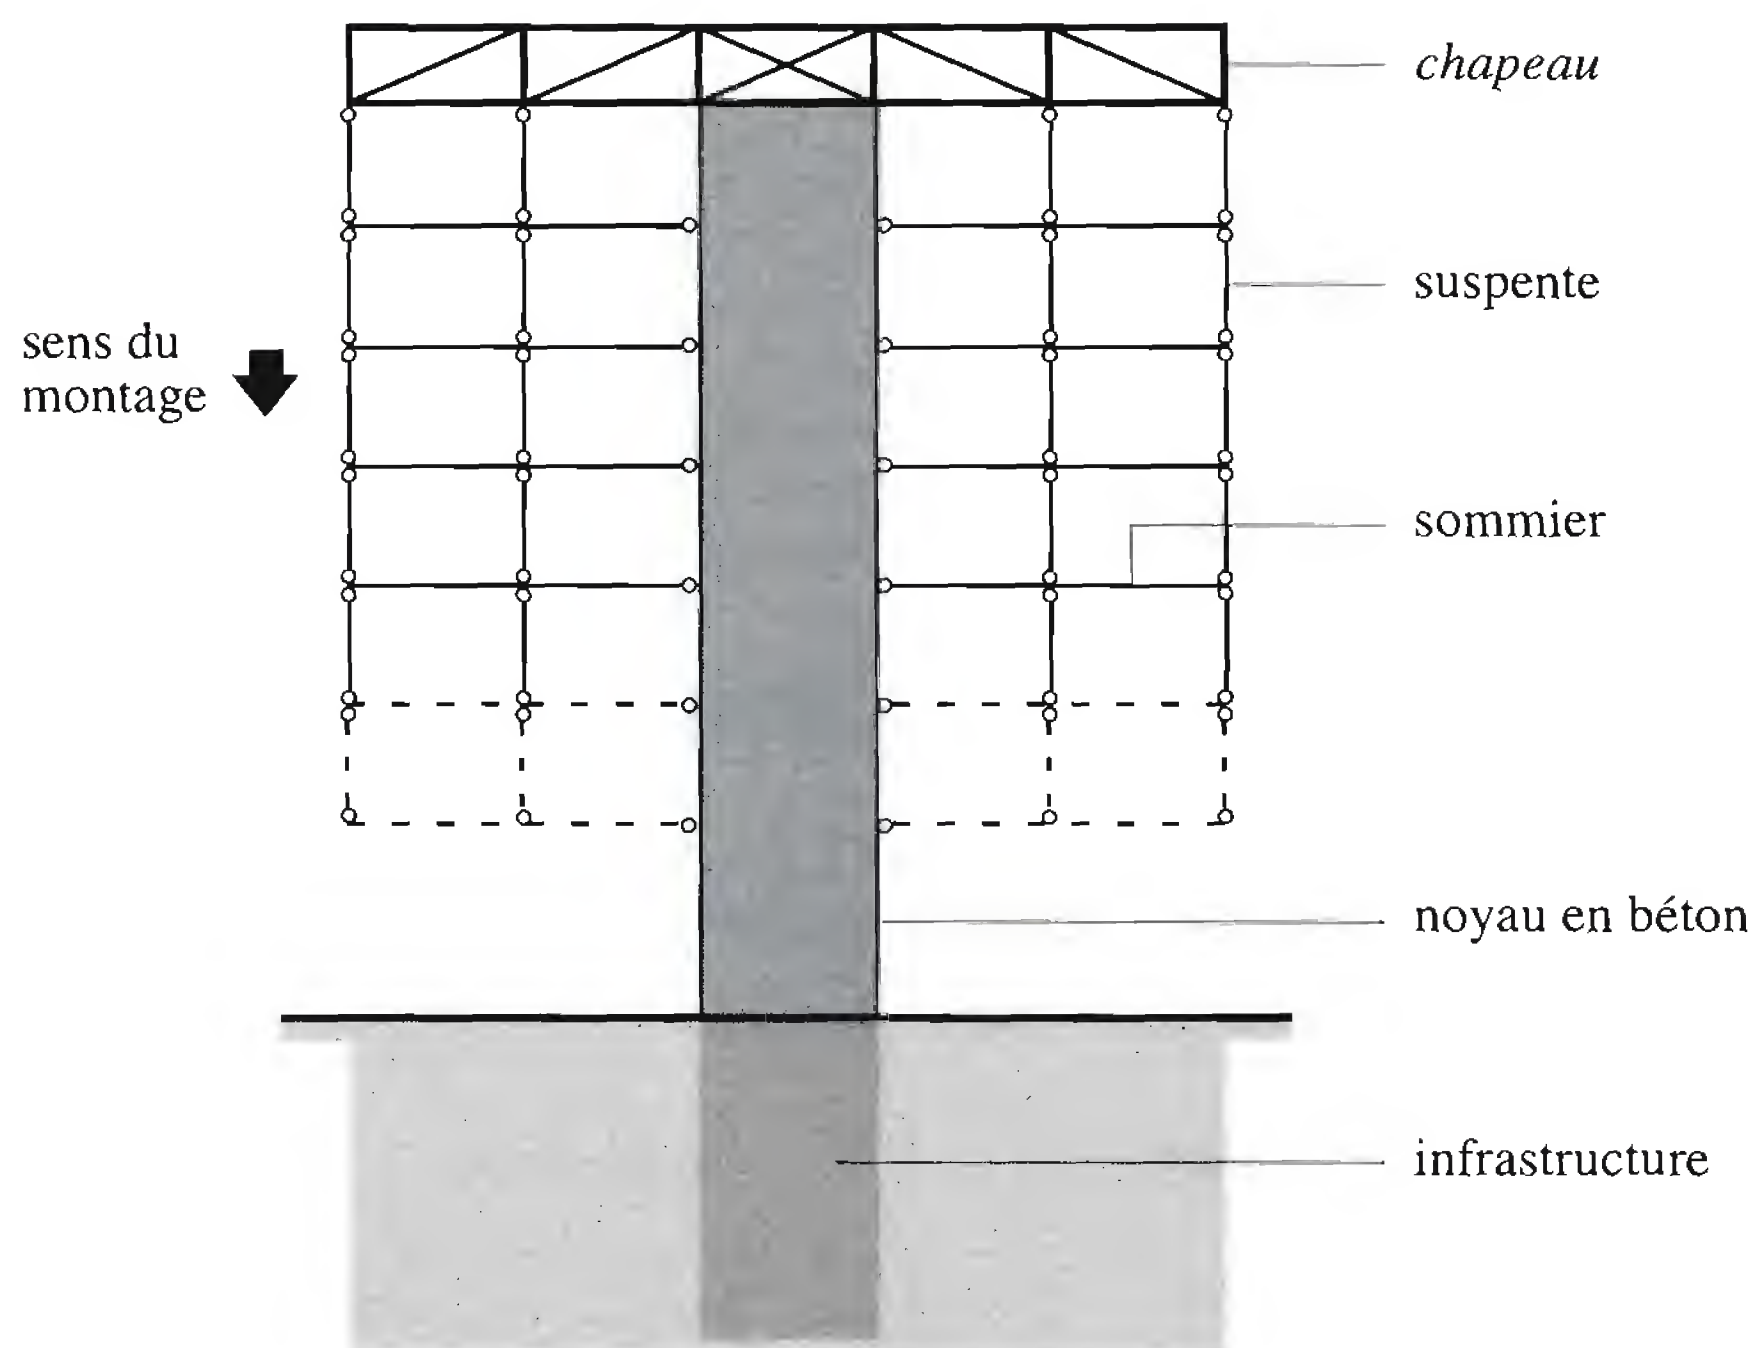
Coupe d'un bâtiment à structure suspendue.
